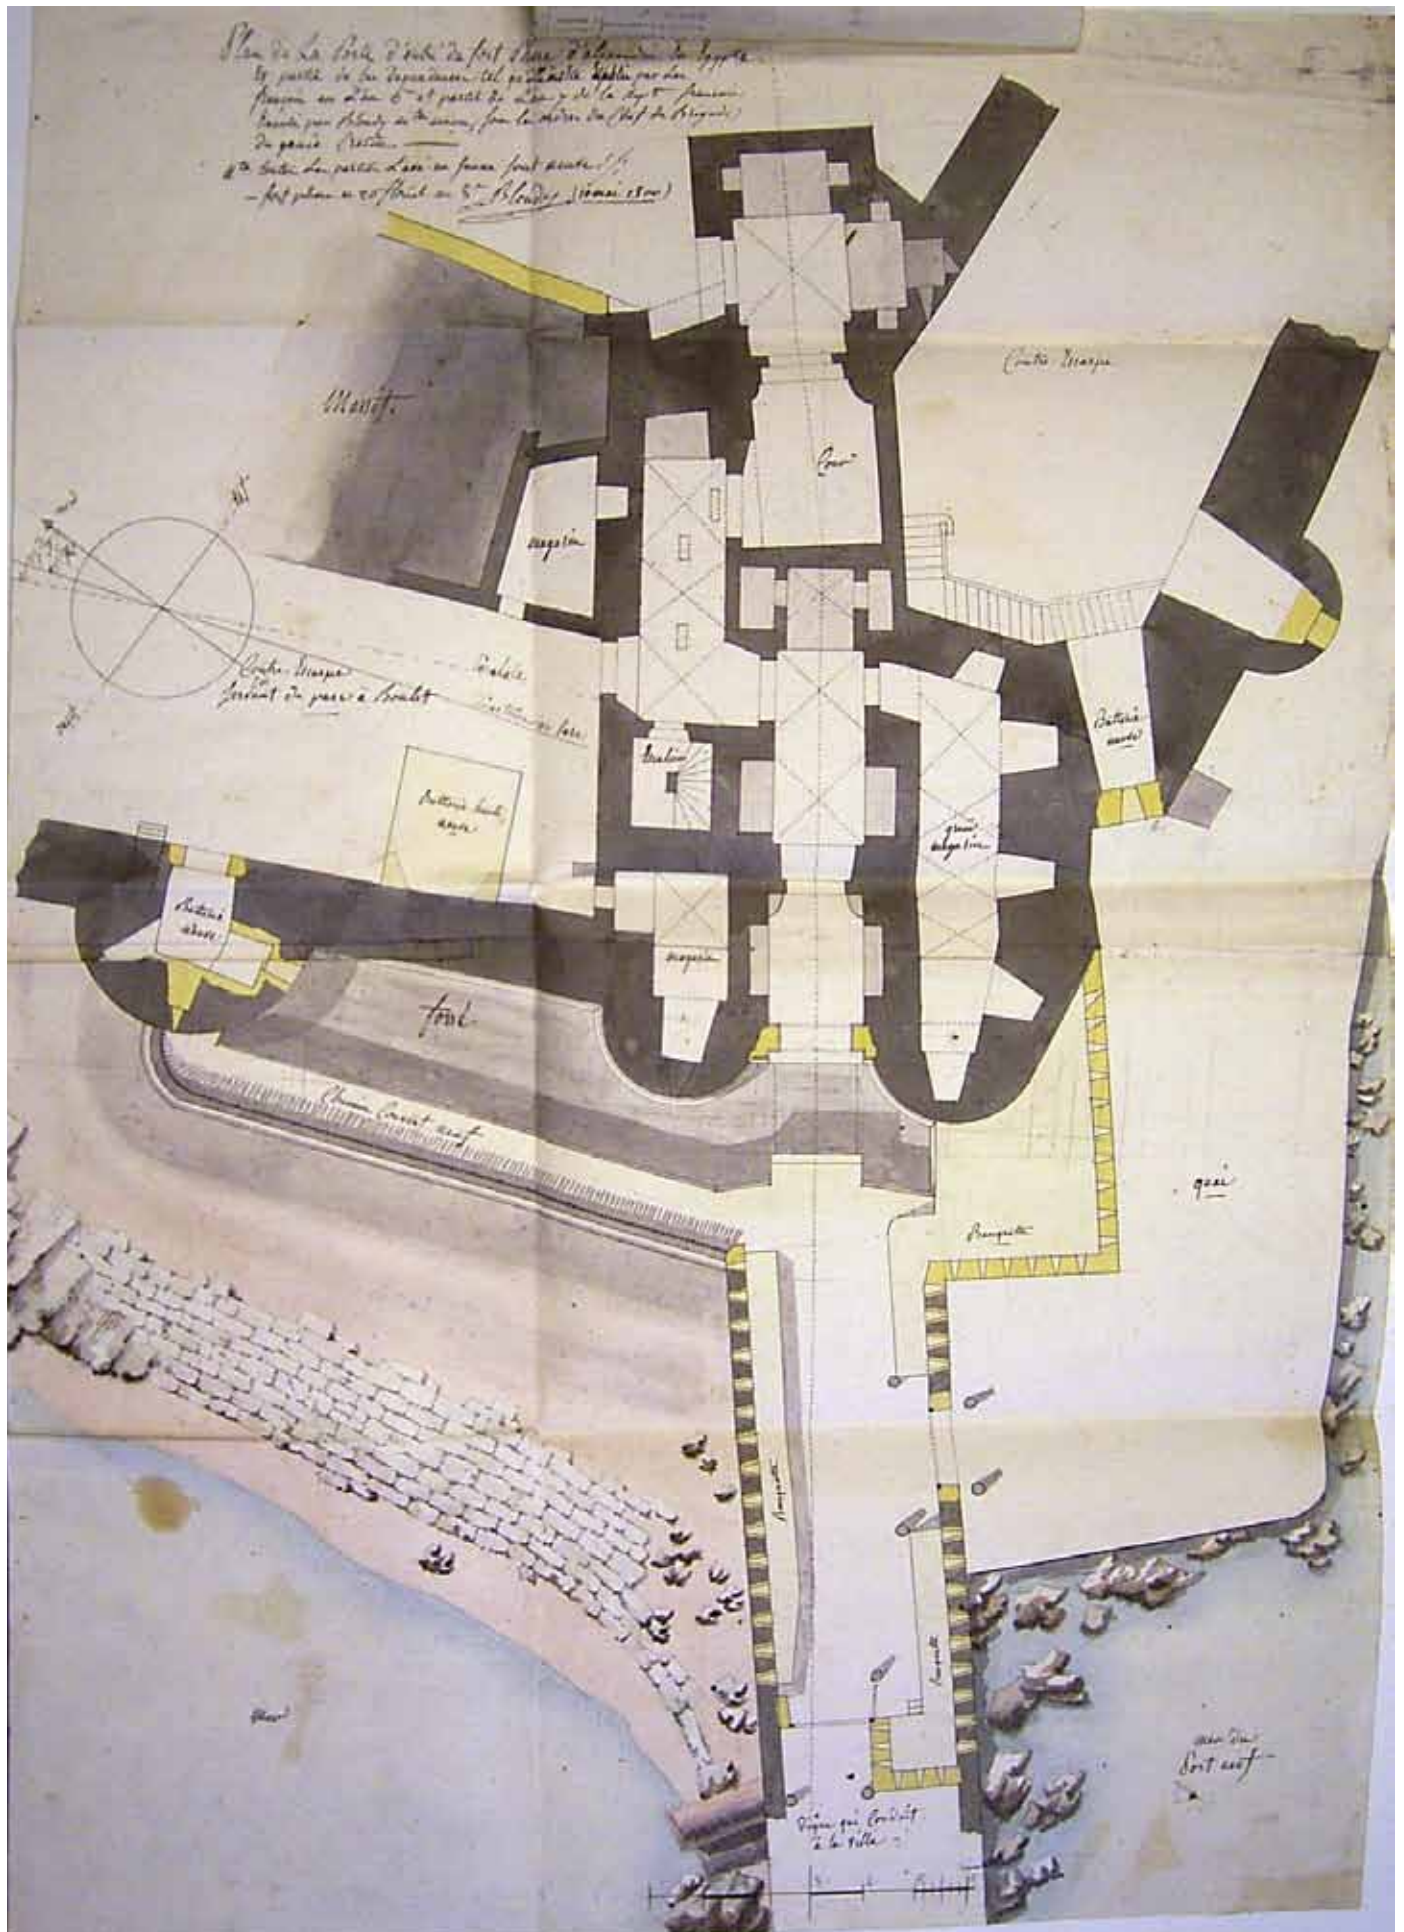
Umbauplanung (gelb) des Torbaus: Grundriss, 1800 (SHAT - 1VM2, Nr. 23).
